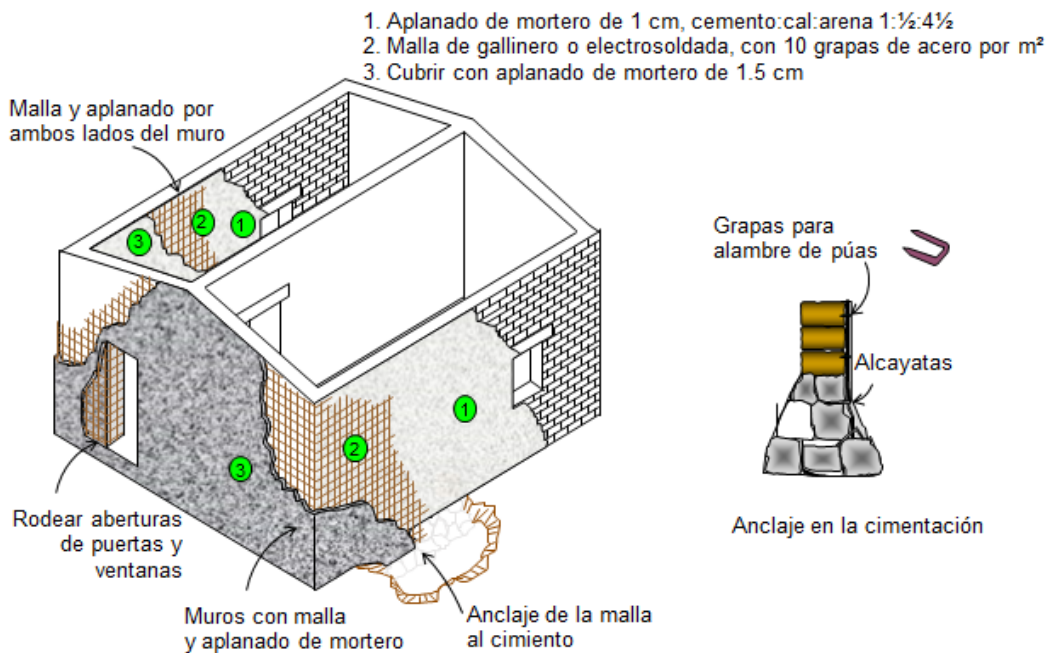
Rehabilitación de edificios de adobe con encamisado de malla y mortero. Fuente: Cortesía del CENAPRED, 1999.
